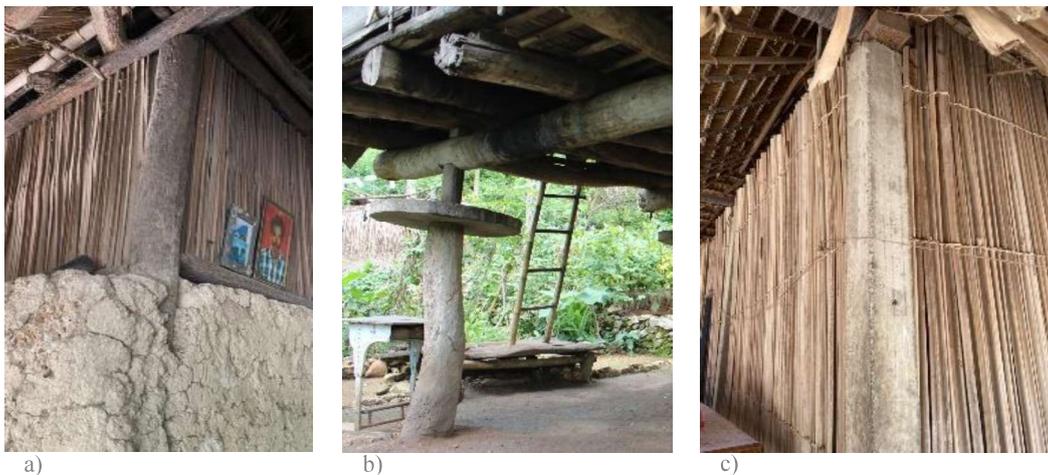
28. Pilares estruturais. a) Pilar de madeira de coqueiro b) Pilar redonda de eucalipto c) Pilar de betão.
